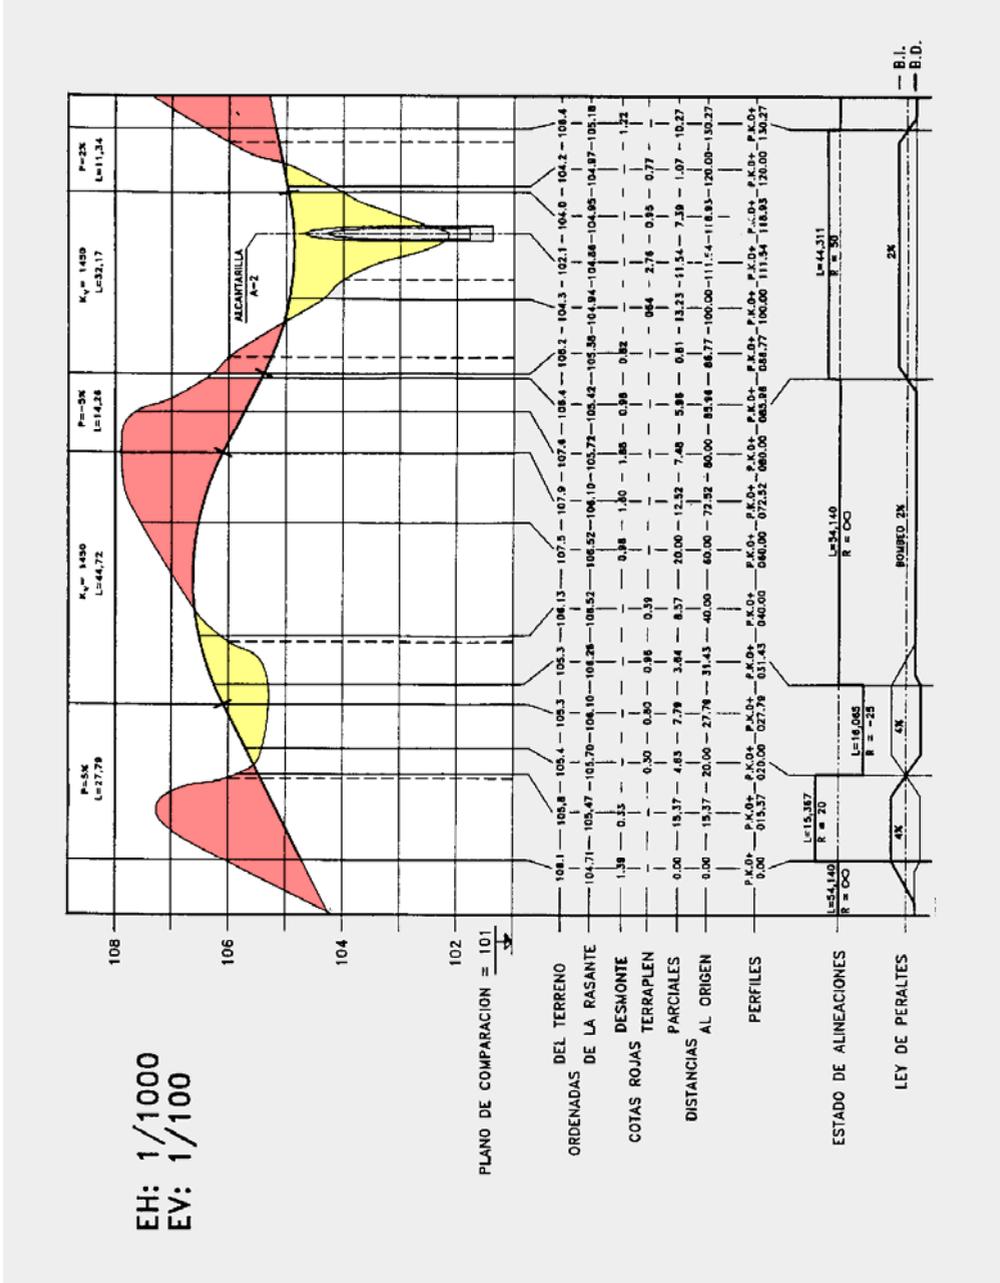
Perfil longitudinal tipo de una carretera
